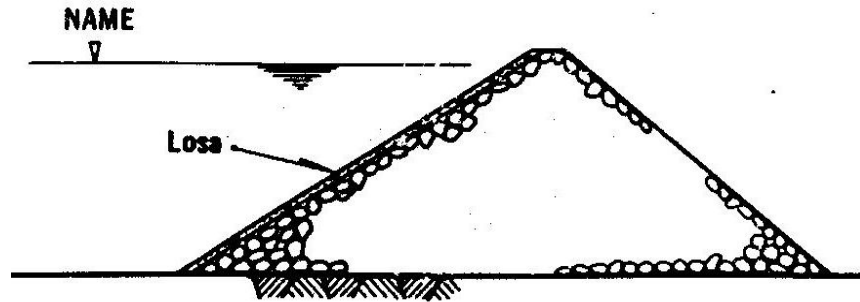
Presa de enrocamiento con losa de concreto o asfalto
